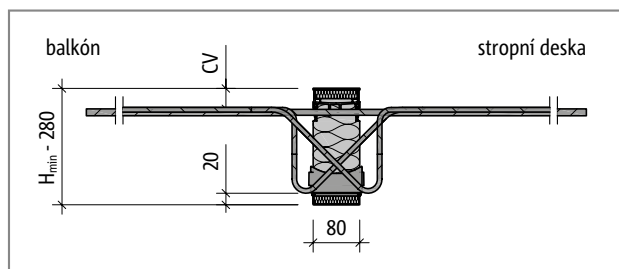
Schöck Isokorb® typ K70M: Půdorys prvku
